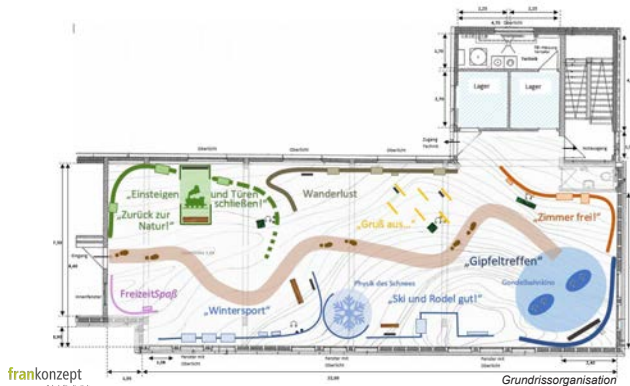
Entwurf des Grundrisses für das Wintersportmuseum
